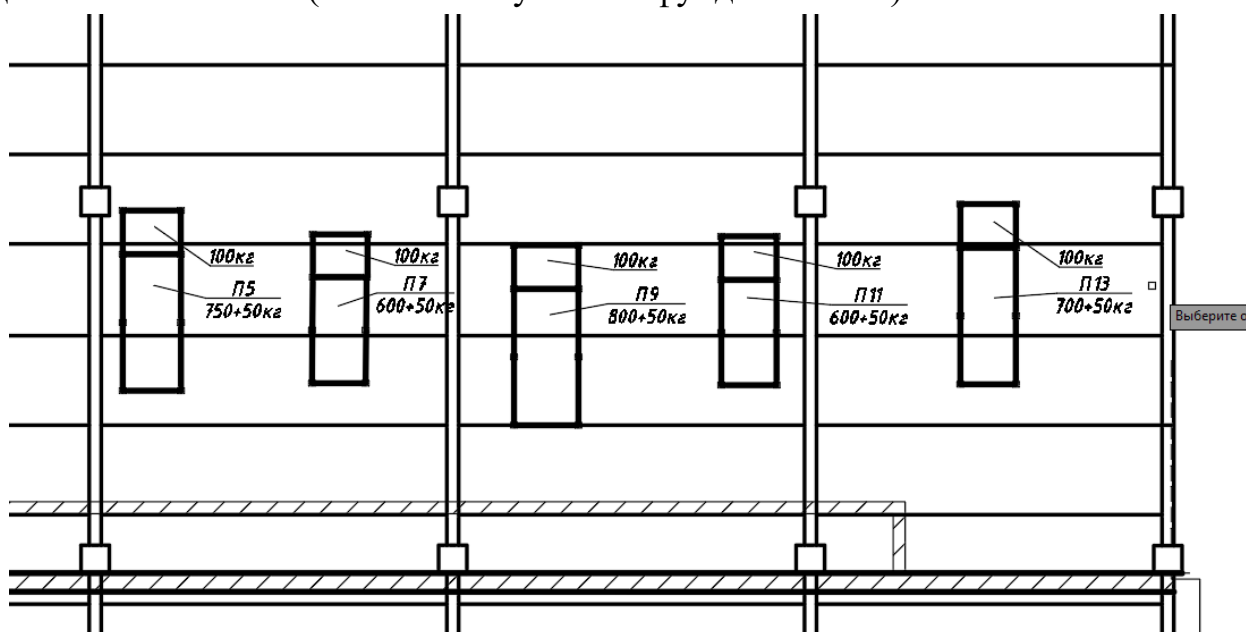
Схема добавляемых нагрузок на существующее оборудование при новом оборудовании в осях 16-19(на схеме не указаны фундаменты Ф)
